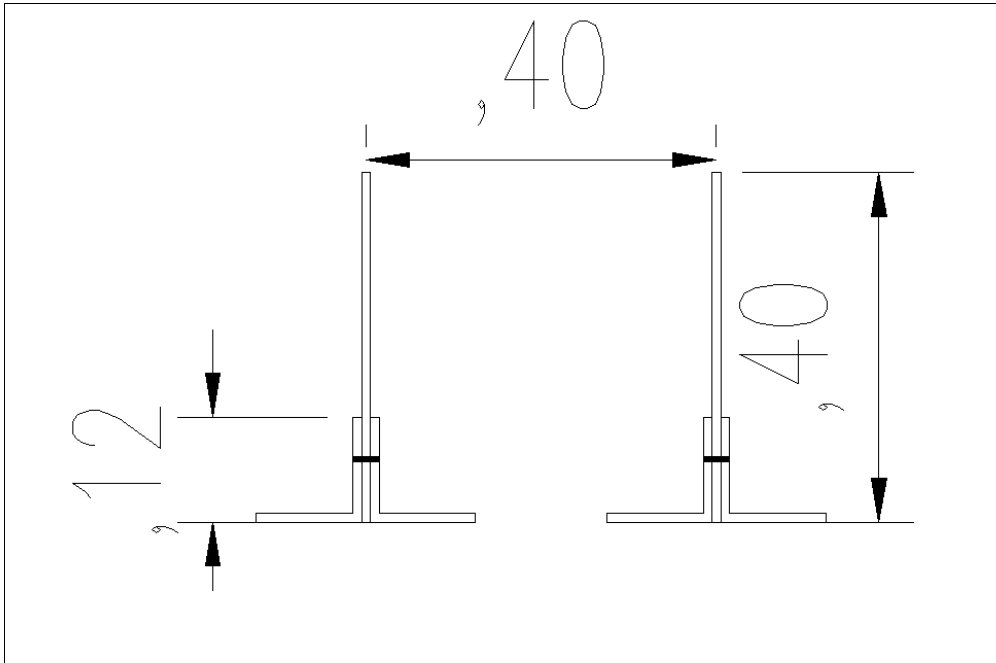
Sección del elemento tipo 1-26, Puente 2. Fuente (Autores).
